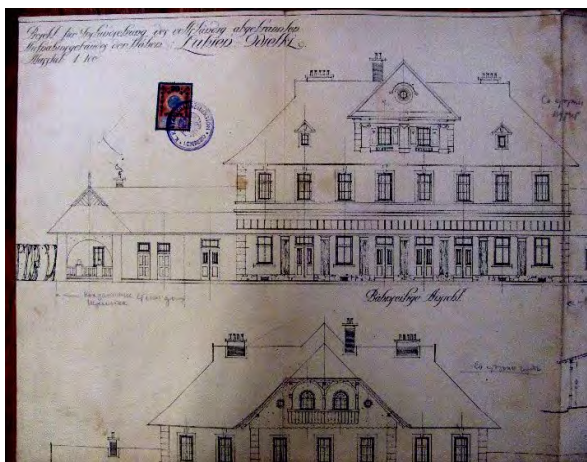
Фрагмент креслення відбудови фасаду будинку вокзалу ЛюбінВел. Фото [10–12].
